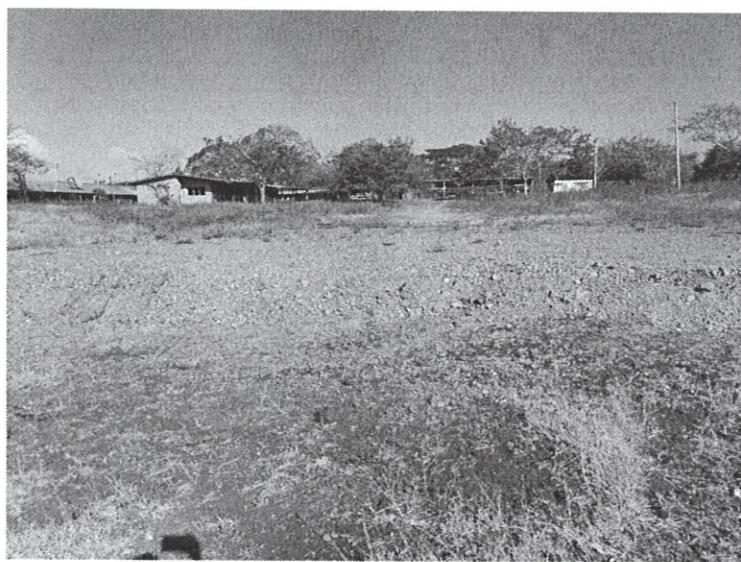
Vista del terreno, donde se llevará a cabo la construcción de la Planta de Procesamiento.
